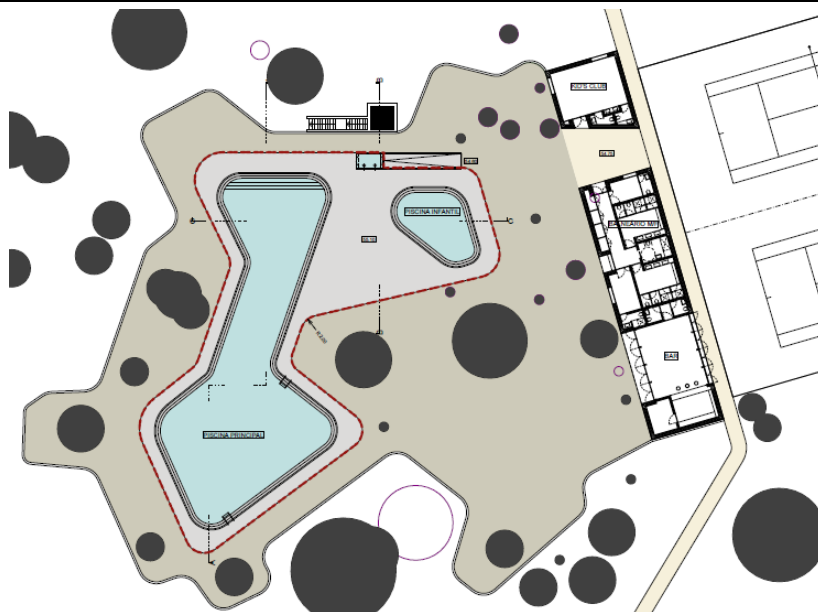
Edifício Central e Edifício de Recepção (pormenor da planta de projeto)
